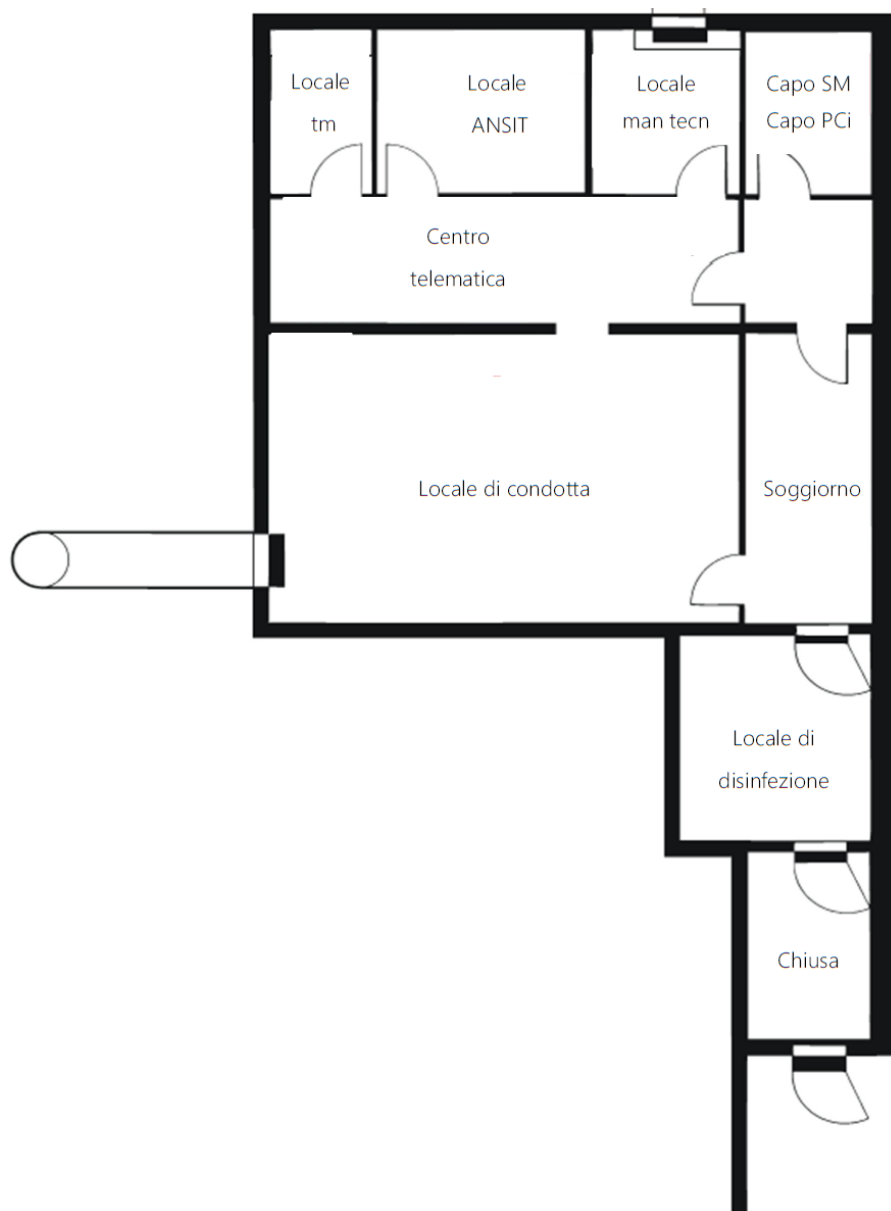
Planimetria di un posto di comando di tipo II ridotto.
